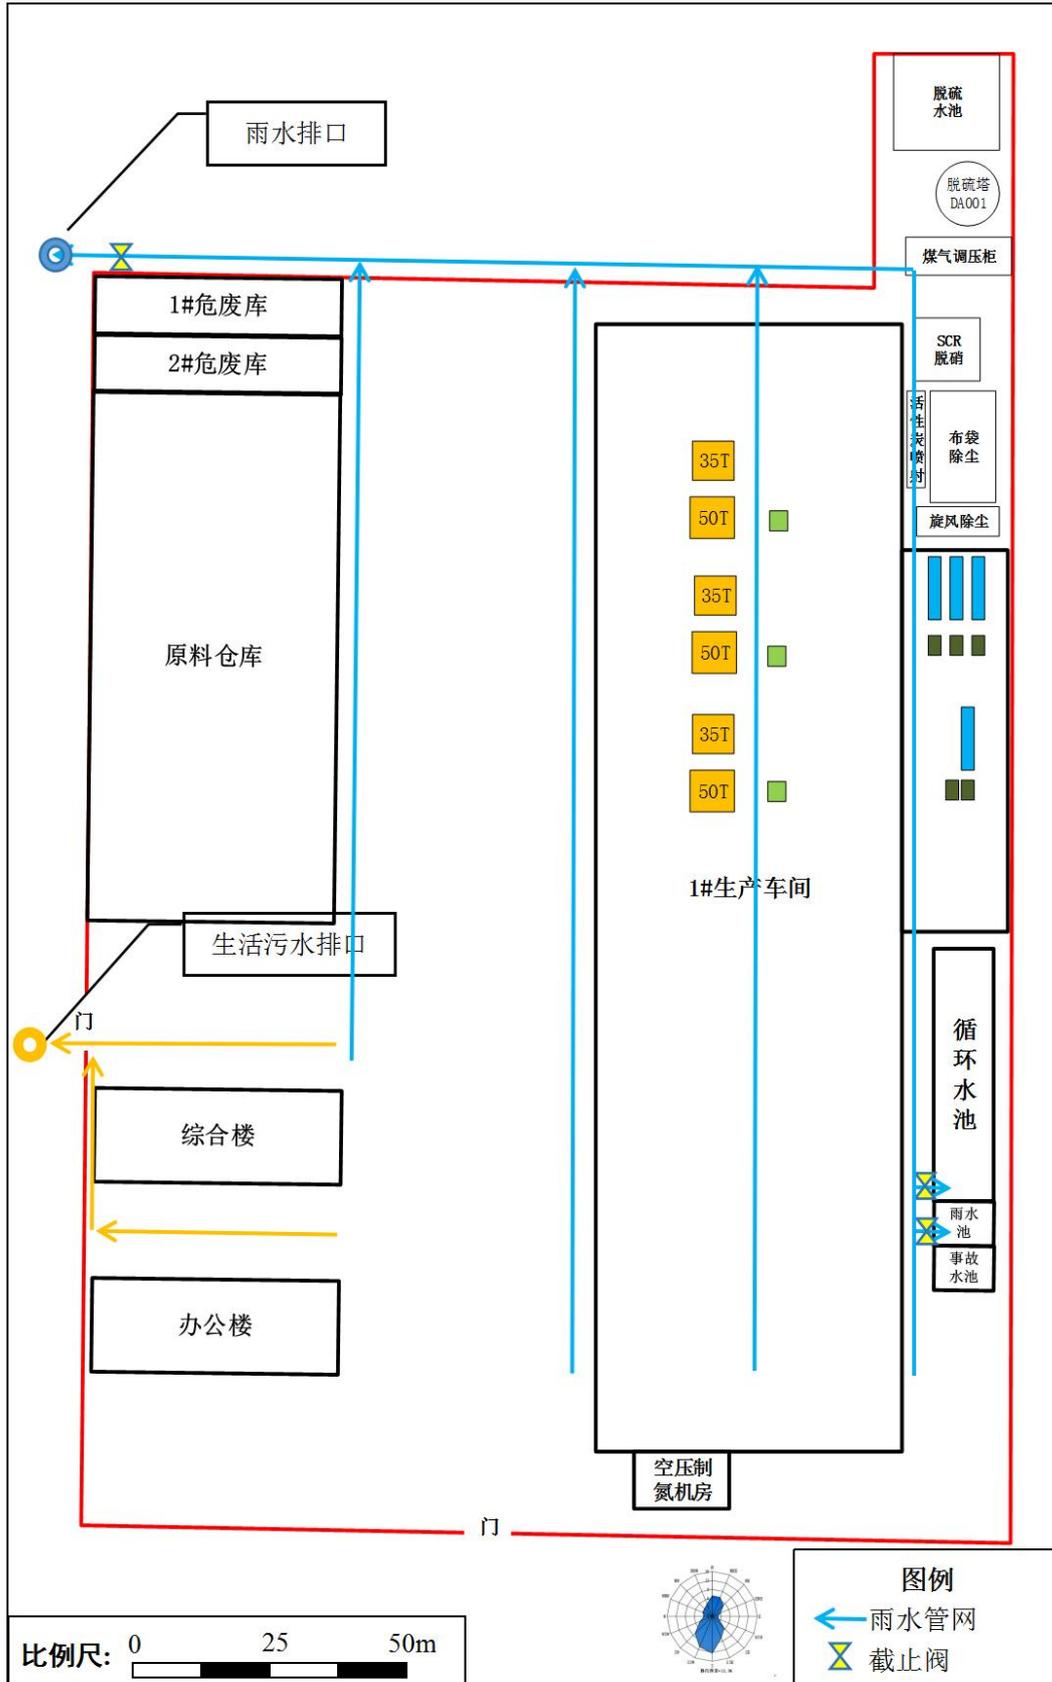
临朐共享铝业科技有限公司厂区总平面布置图
